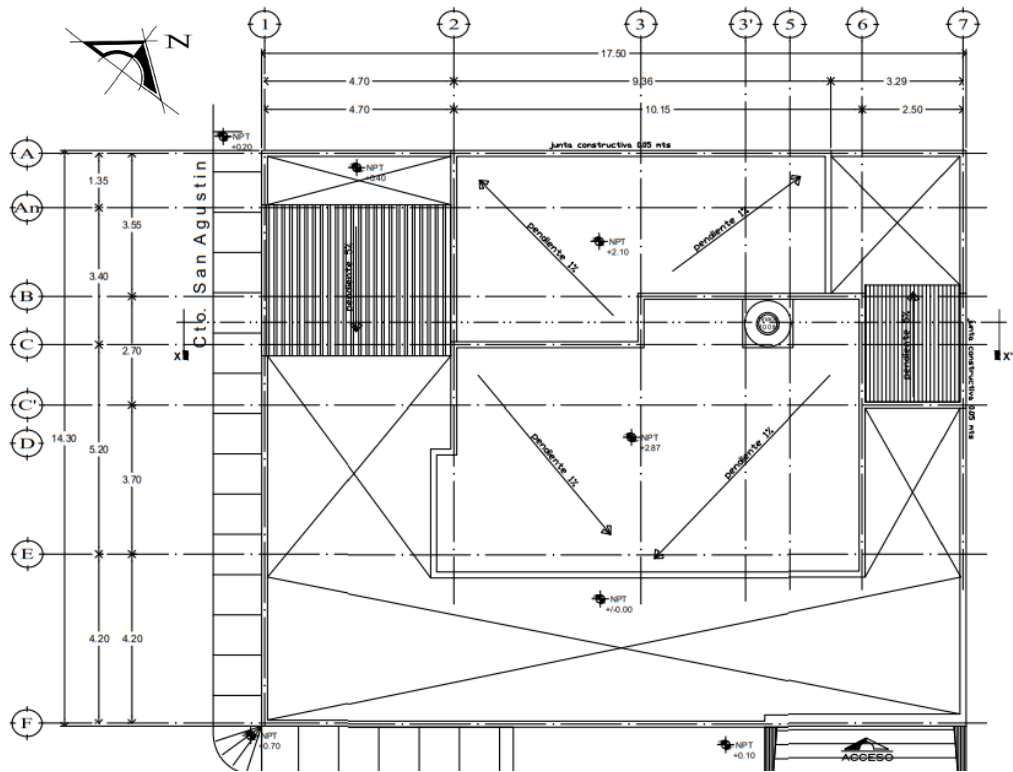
Planta de conjunto, caso Leticia Navarro Alfaro. Elaboración propia.
